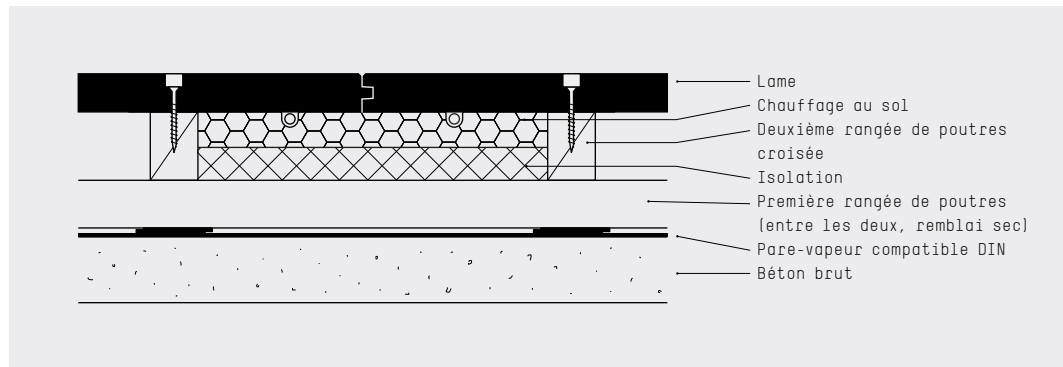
vissage sur système de chauffage au sol en construction sèche
